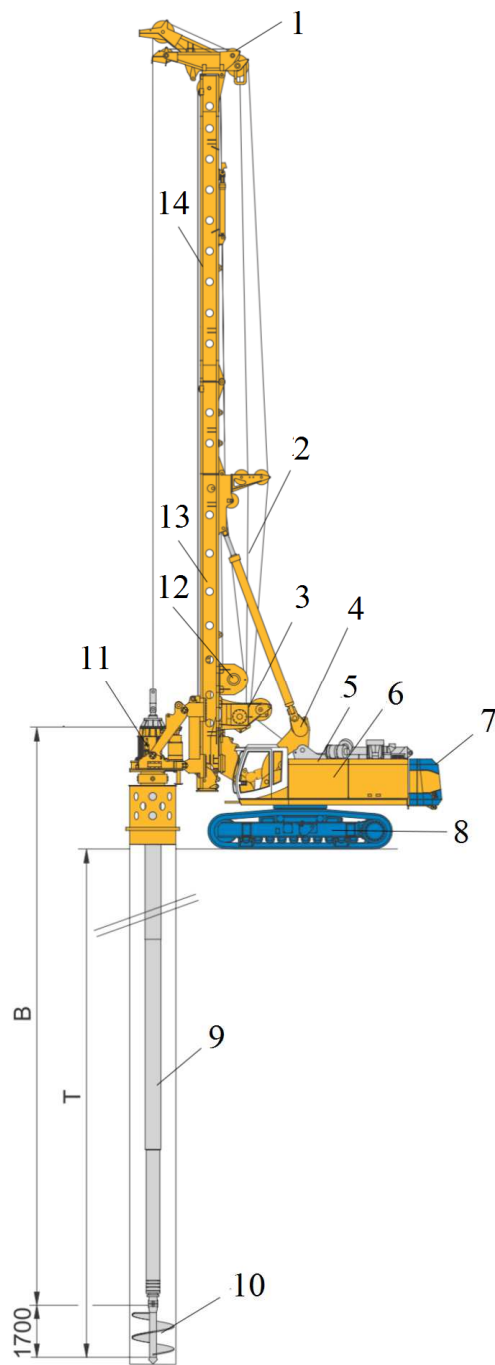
Бурова установка BAUER BG 40: 1 – головка щогли з направляючими шківками; 2 – троси лебідок; 3 – допоміжна лебідка; 4 – опорна консоль з циліндрами нахилу щогли; 5 – головна лебідка; 6 – моторний відсік; 7 – противаги; 8 – гусеничне шасі; 9 – бурова штанга-келлі; 10 – буровий шнек; 11 – привід обертання; 12 – лебідка подачі; 13 – нижня частина щогли; 14 – верхня частина щогли
